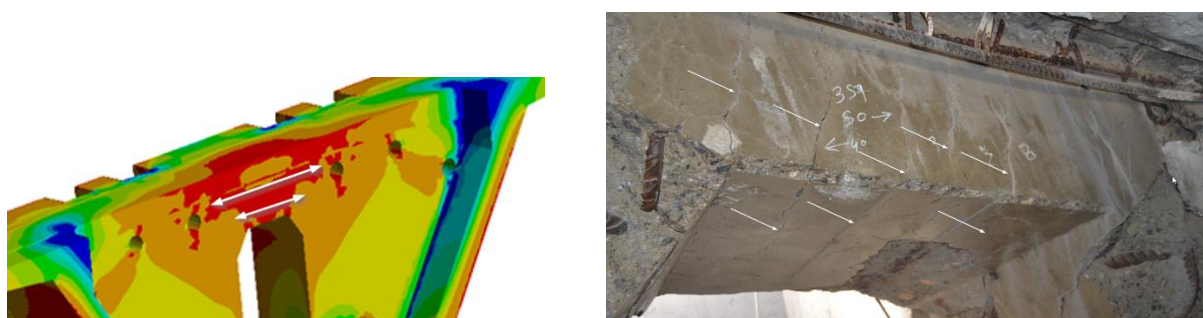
Mamparo 2 del vano 1 (colapsado) Fisuras compatibles con la rotura de la losa superior y flexión de eje vertical del mamparo.
